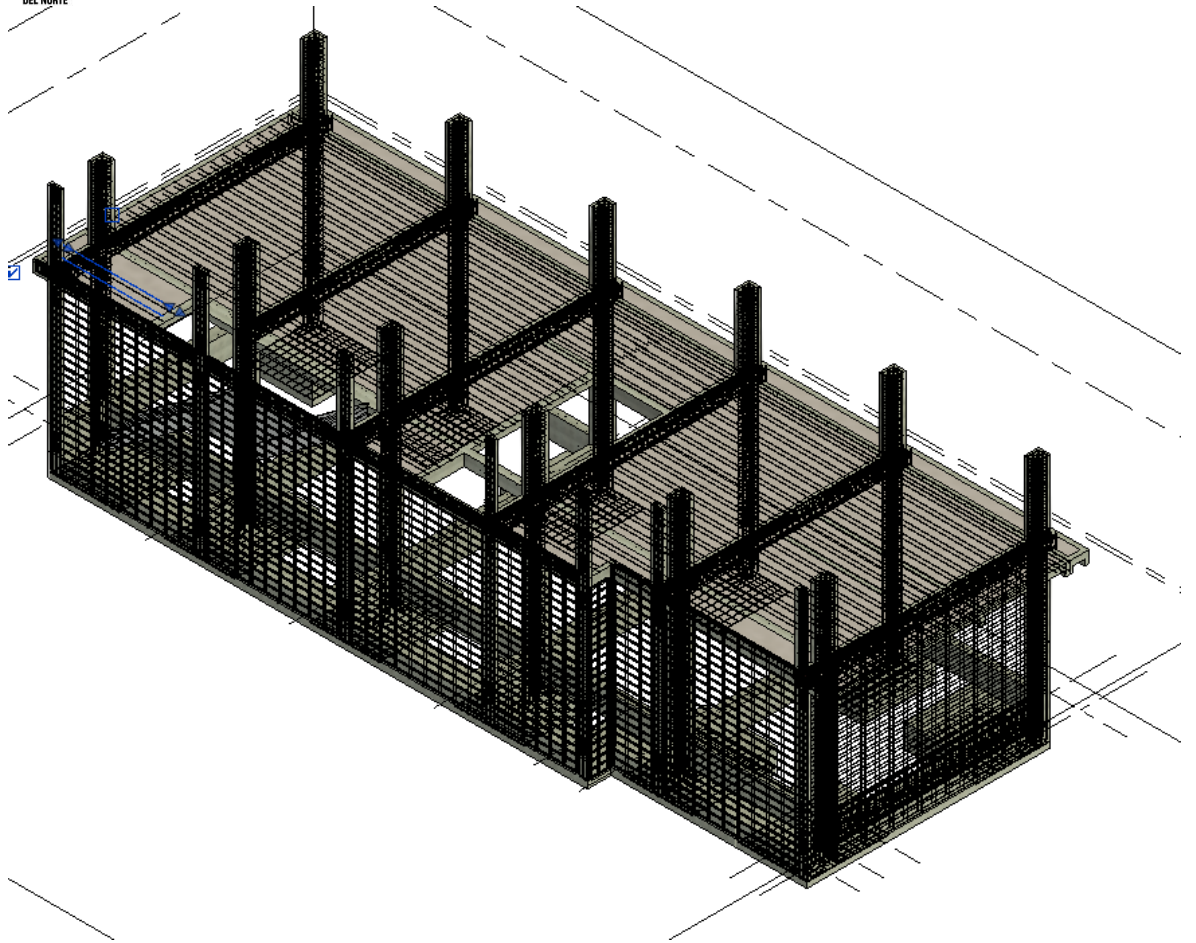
Vista 3D, distribución de acero en Losa Aligerada (Fuente: Elaboración Propia).
